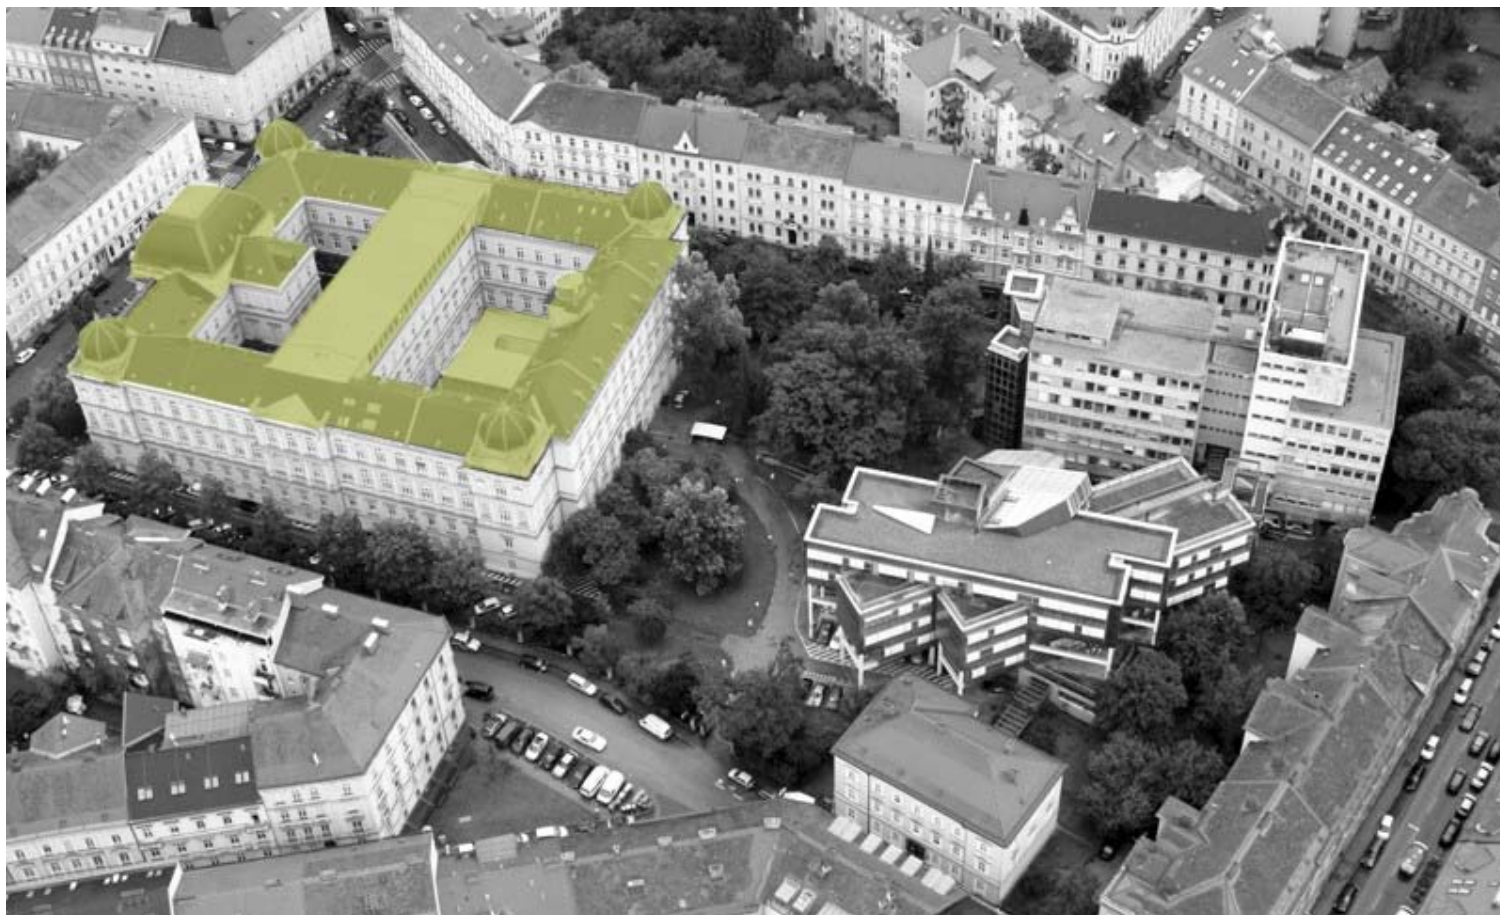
Planungsbereiche am Hauptgebäude: Innenhof und Dachgeschoss der Alten Technik der TU Graz
